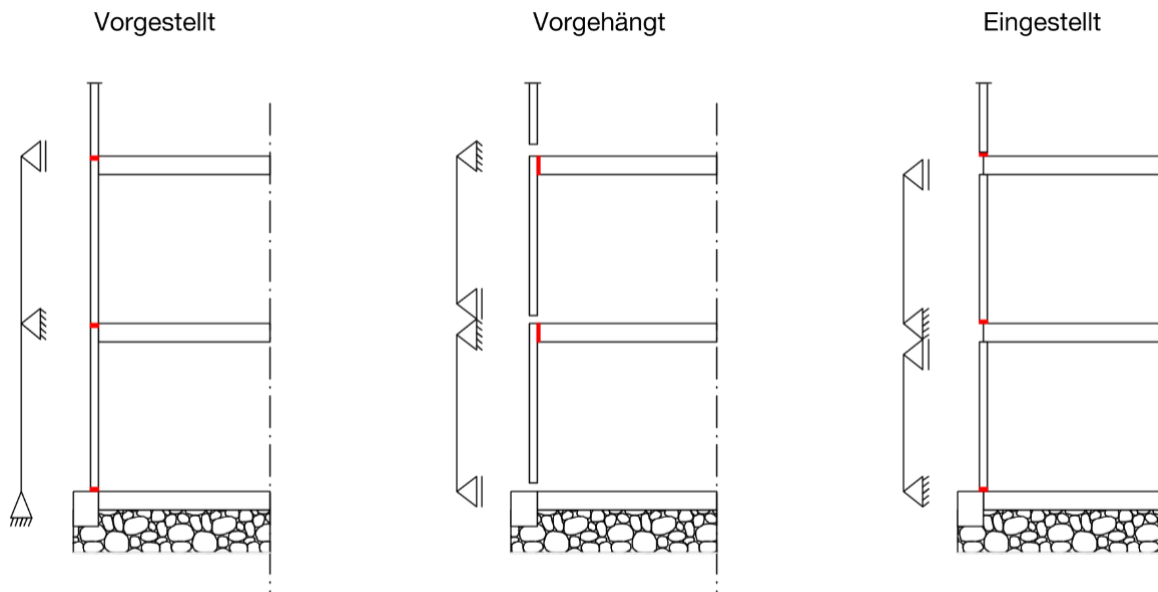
Anschlussvarianten nichttragender Fassadenelemente
